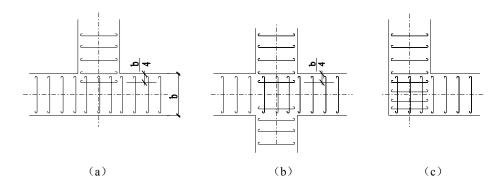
条形基础纵横交叉处钢筋设置示意图
